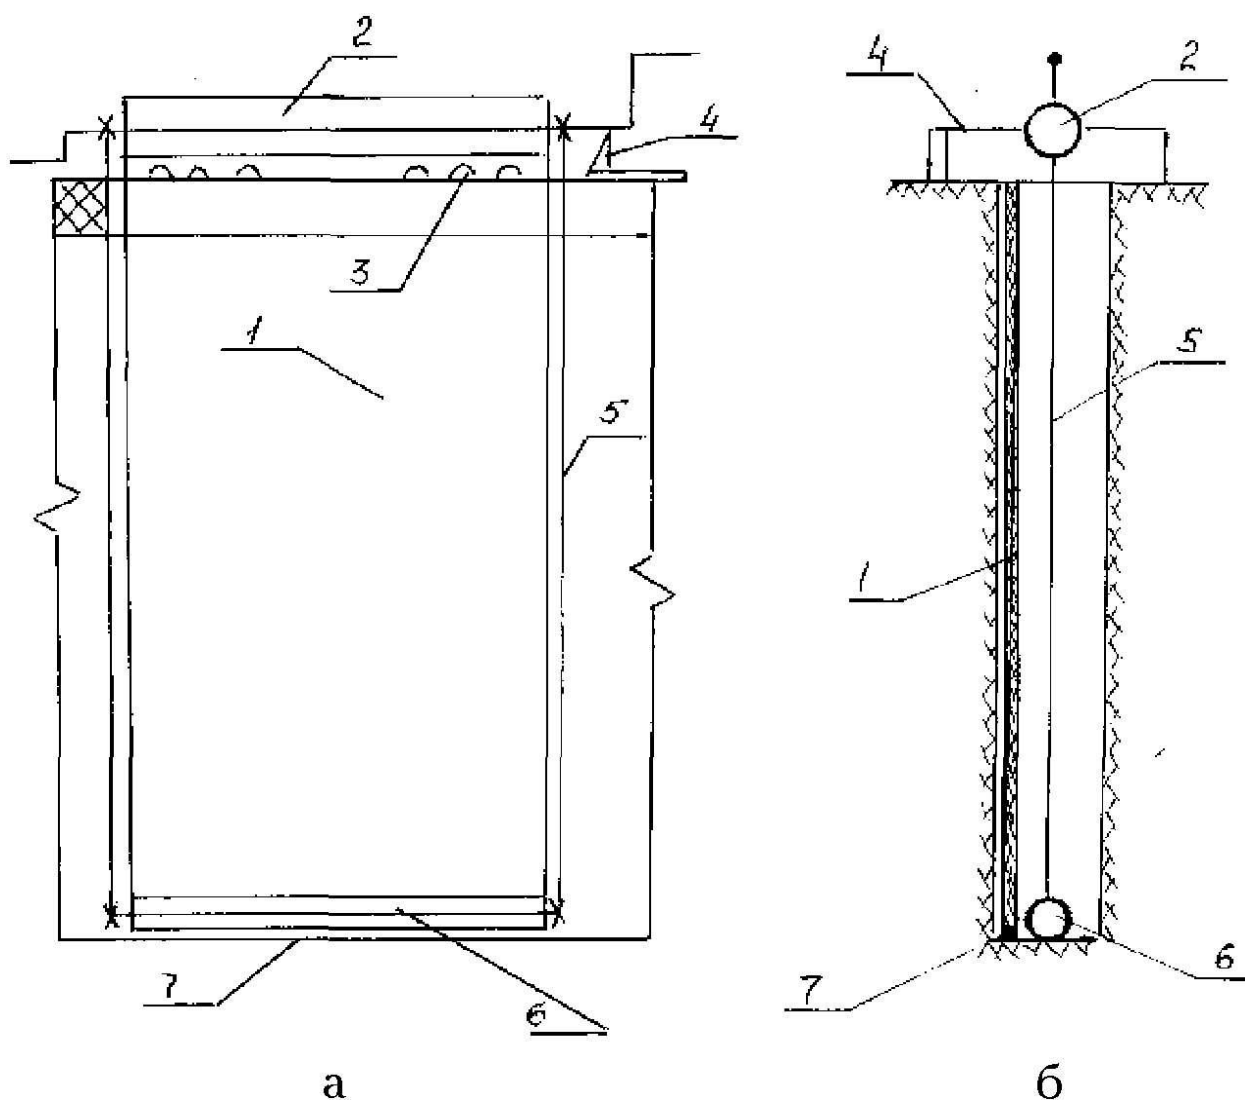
Установка для укладки пленки на стенке траншеи
